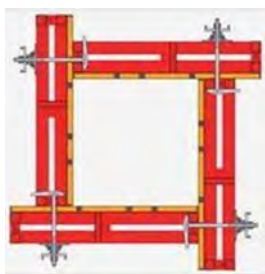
Схема соединения щитов опалубки ступеней фундамента винтовыми замками ВК-260
